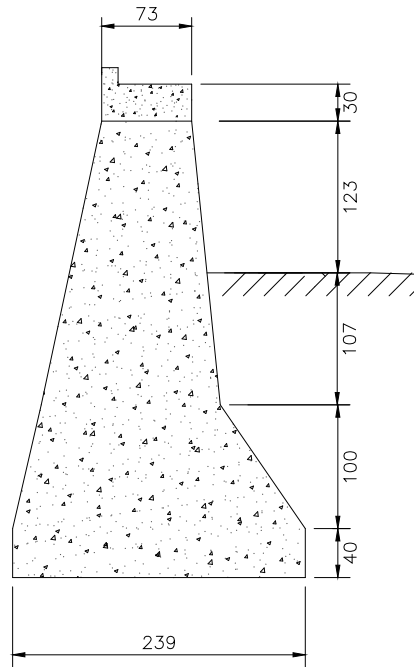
Geometría de los Estribos Conforme a Proyecto
